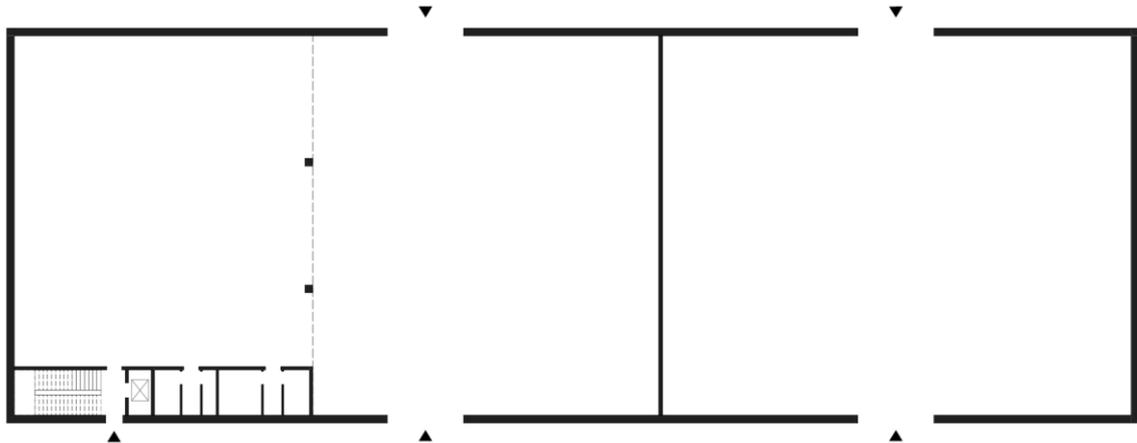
Vorentwurf Grundriss Erdgeschoss SGA
